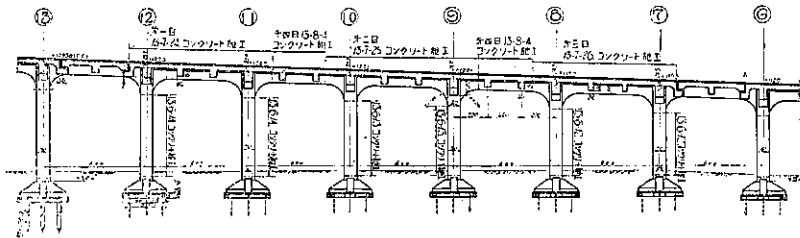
縦断面圖 (コンクリート施工區劃を示す)
